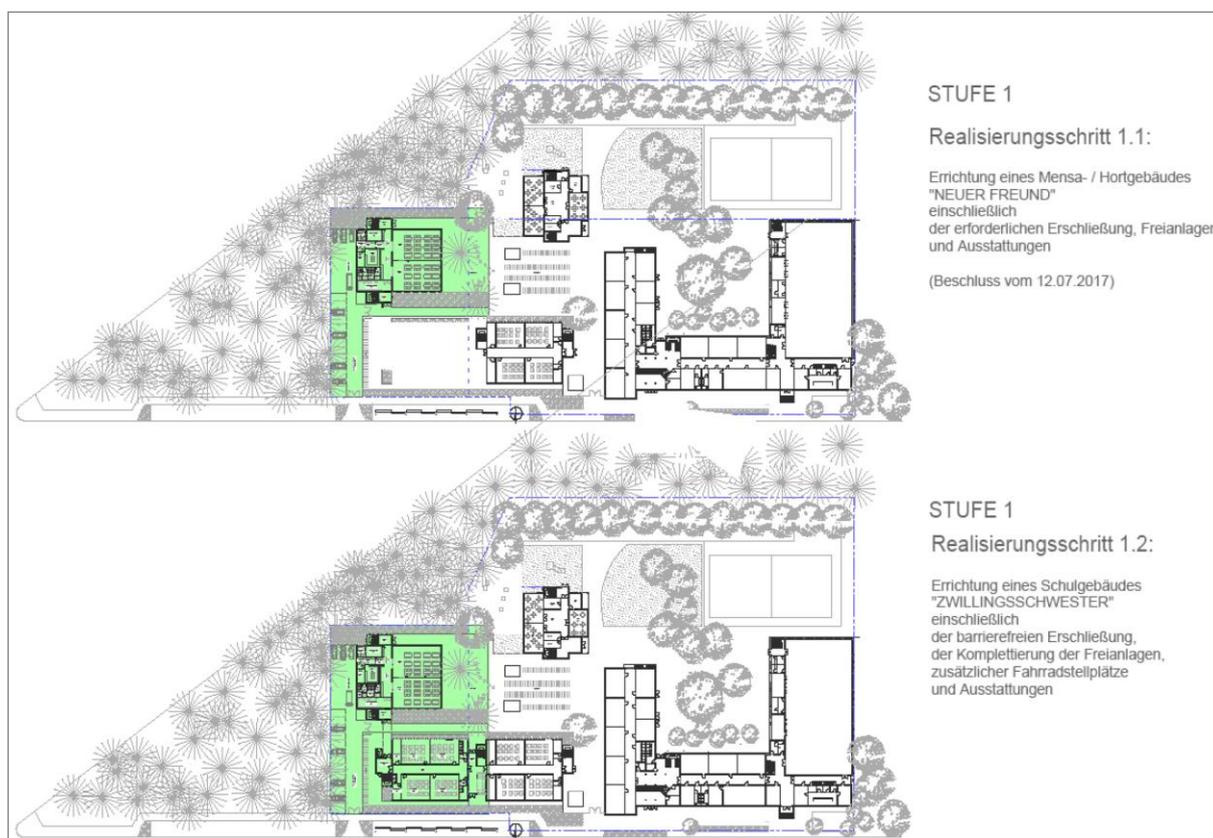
Darstellung zur geplanten Erweiterung des Grundschulstandortes
